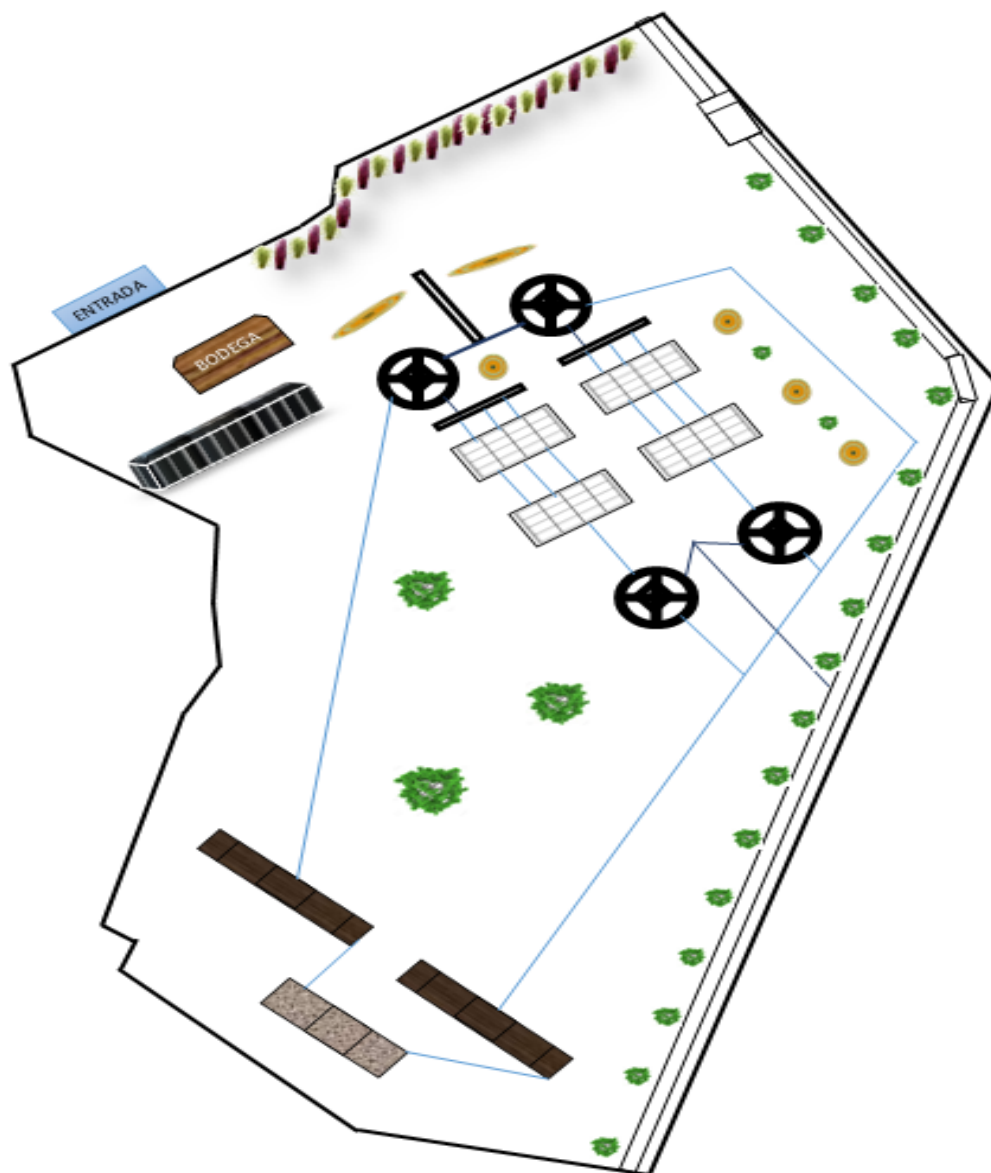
Croquis de las áreas a jardinizar en la planta de tratamiento de aguas residuales Santa Isabel II
